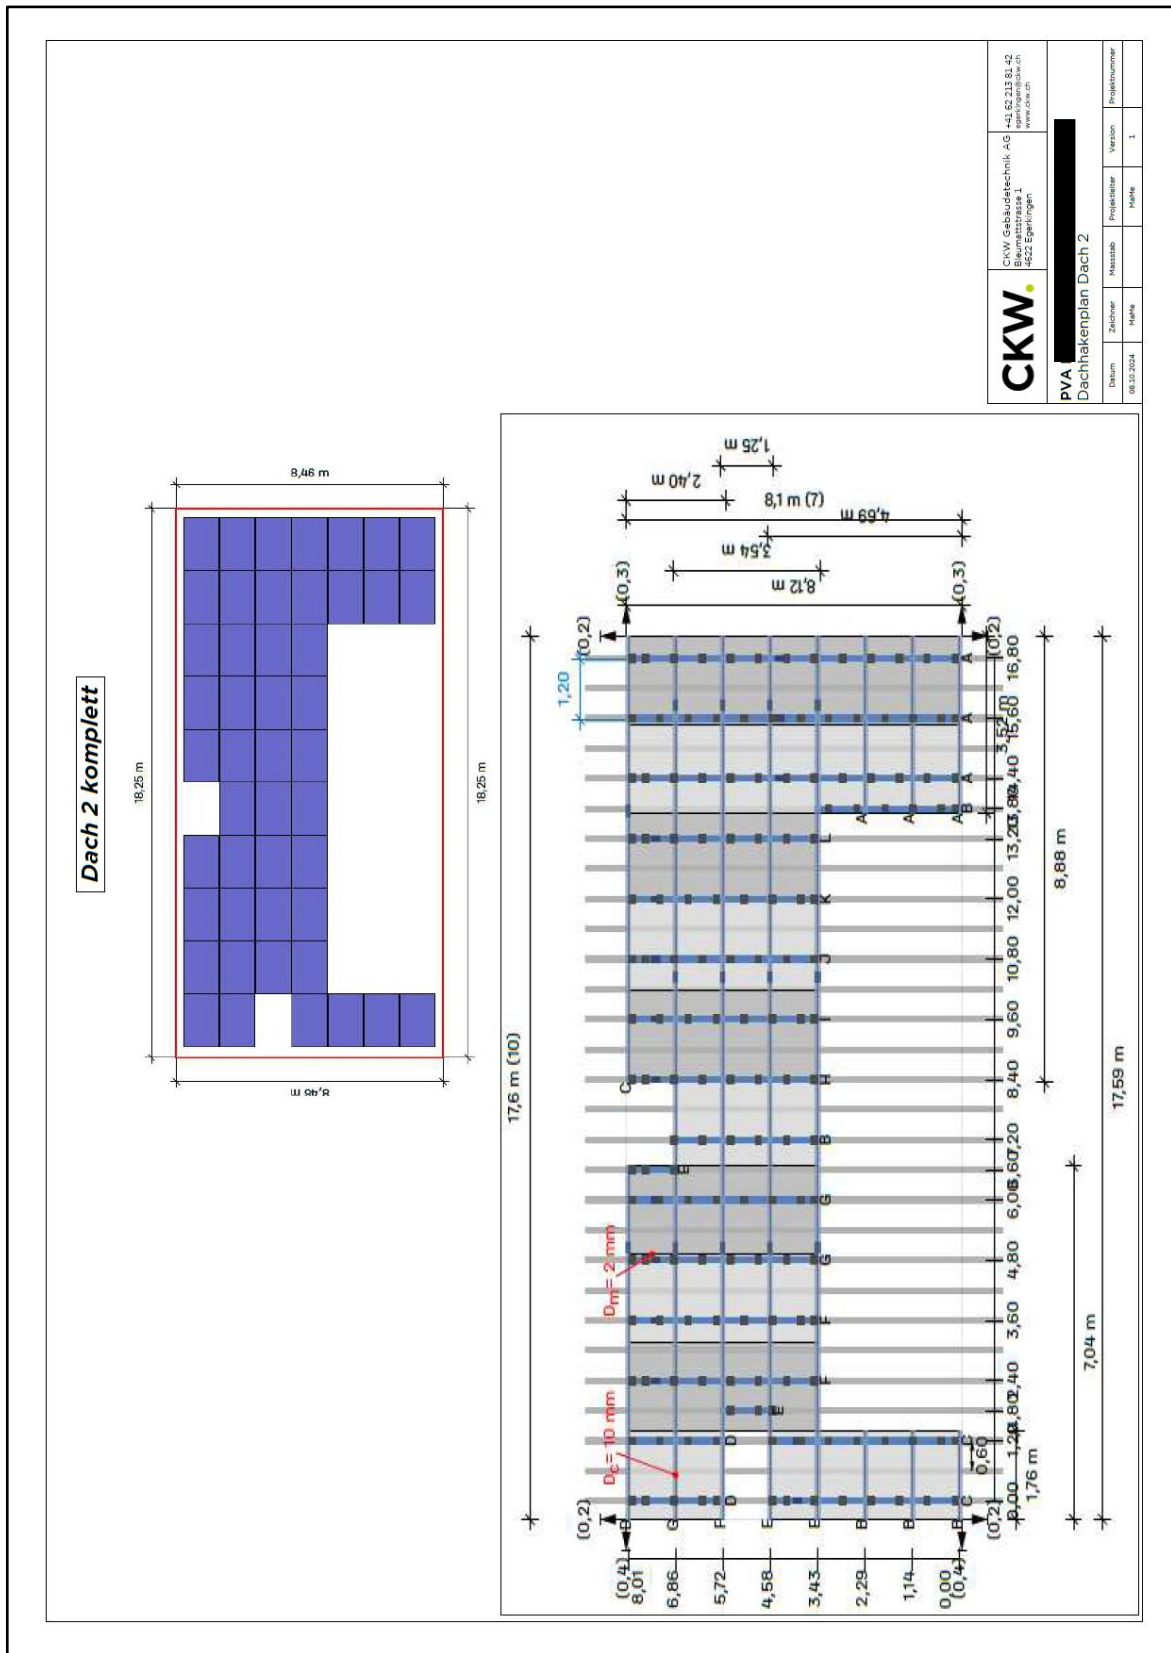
Dachhakenplan Dach 2 (Sketch Up.com)
